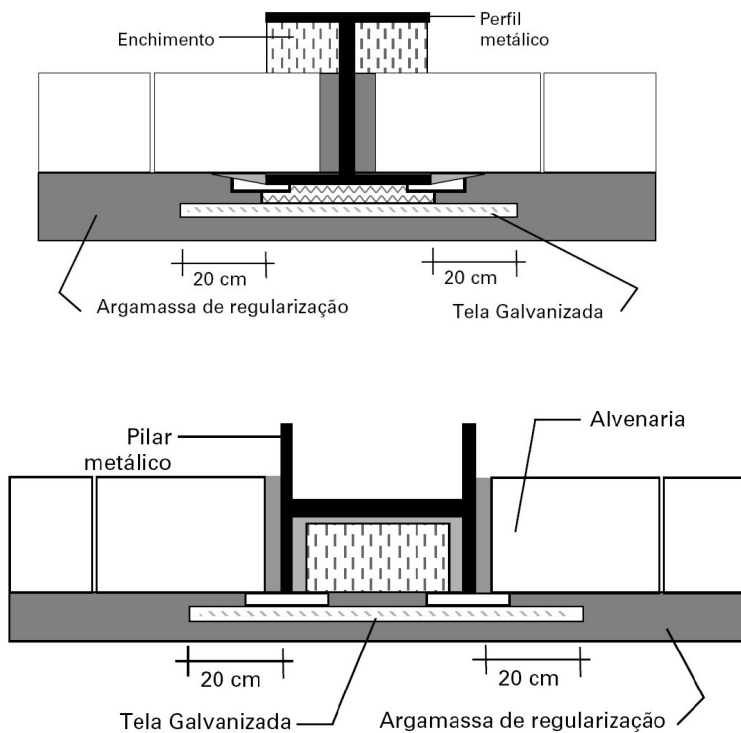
Detalhes genéricos para revestimento em argamassa sobre perfil metálico, em seqüência de execução.
